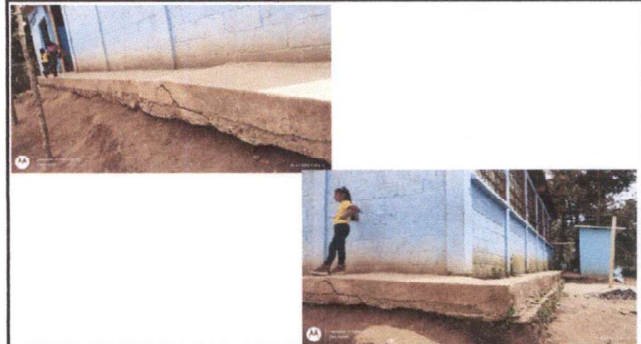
REPARACIÓN DE MUROS DE CONTENCIÓN. Reparación y Aplicación de sabieta en banquetas de concreto en interior y exterior del establecimiento educativo.
